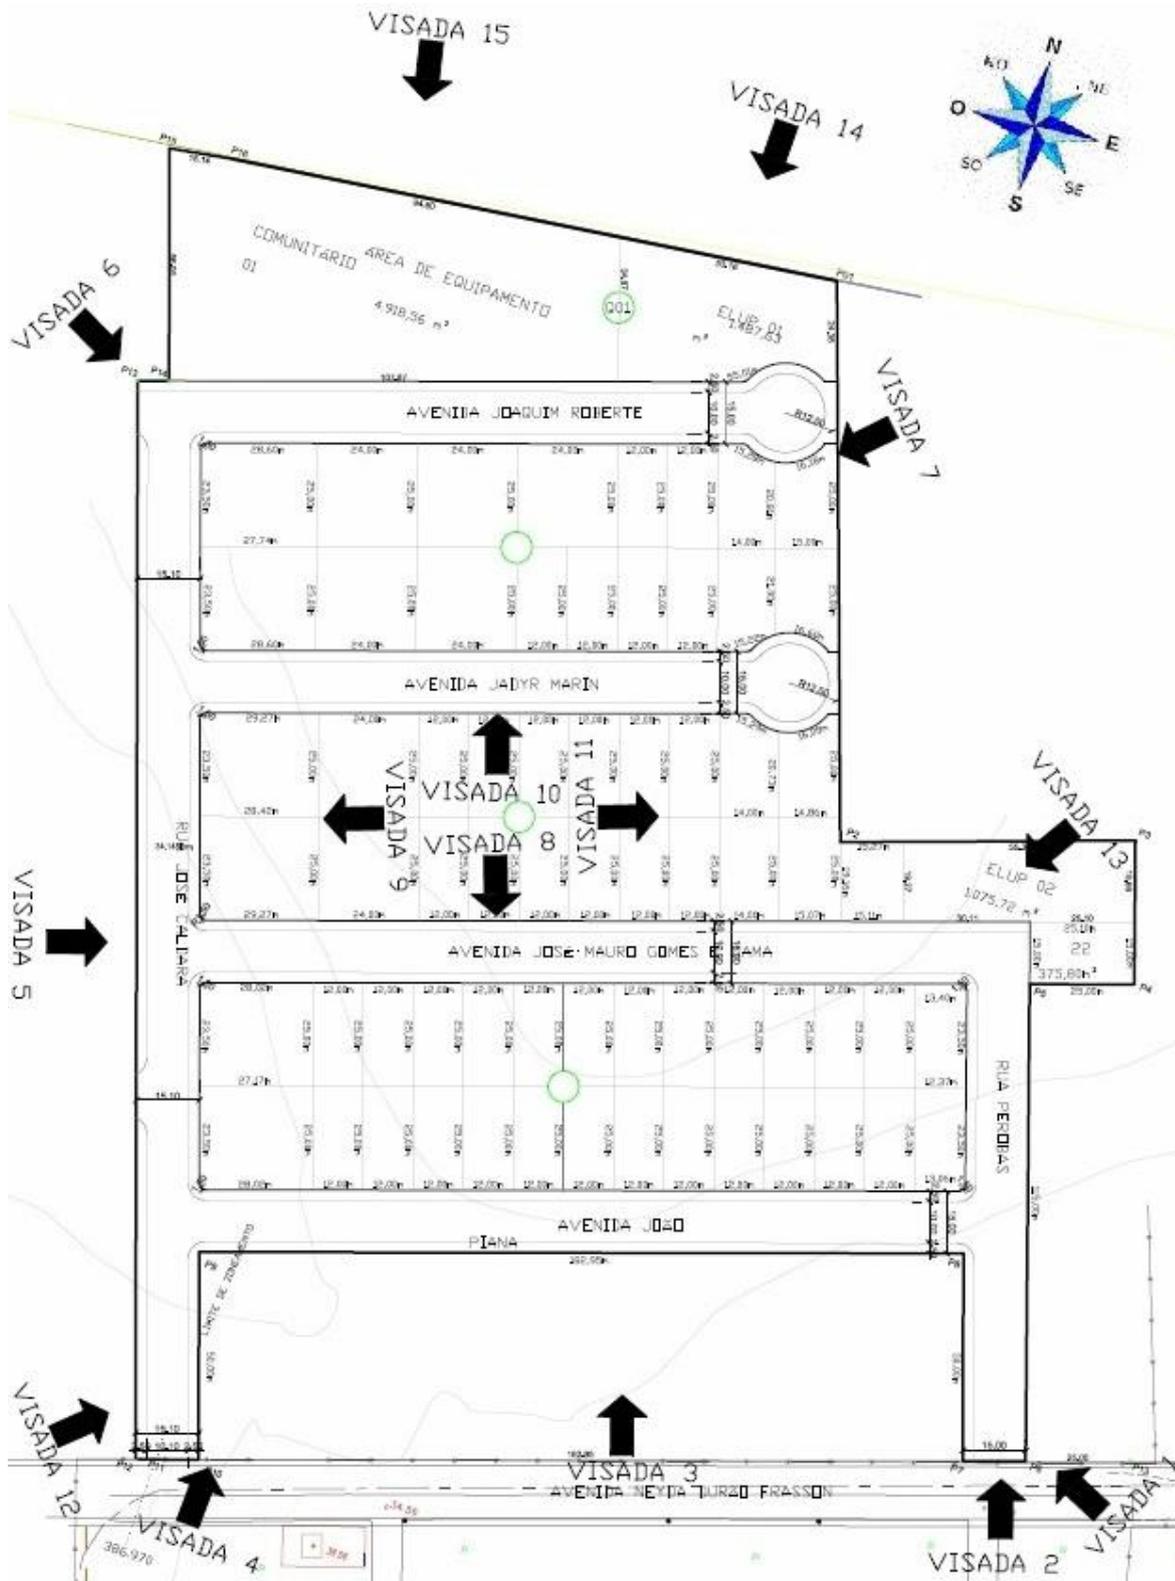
Planta com as visadas, sem escala. Fonte: autor, 2016.
